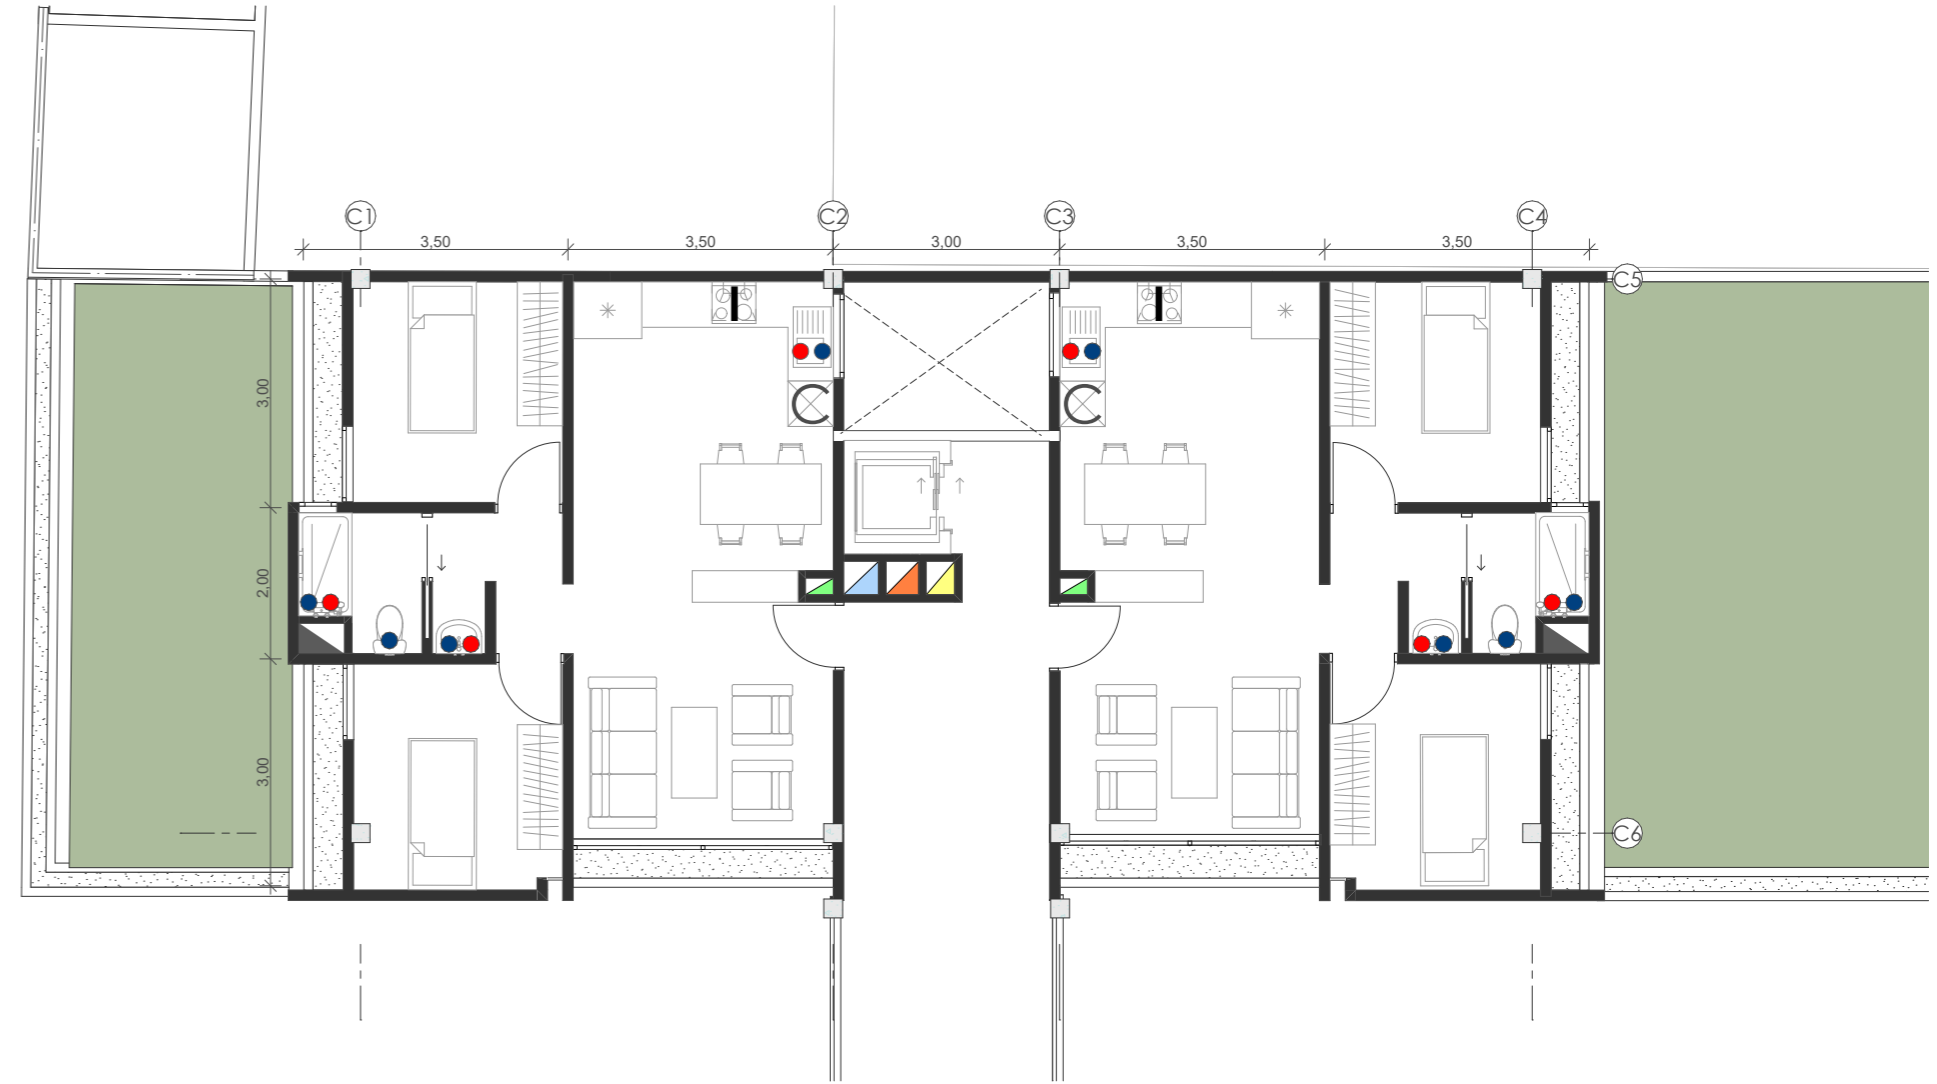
Planta Alta del Bloque C Elaboración propia (2026). Escala 1:100
